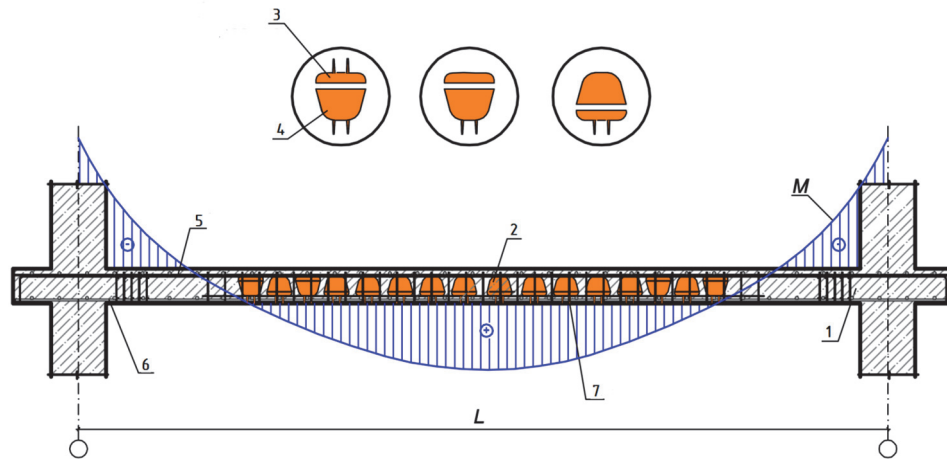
Конструкция чередования пустотообразователей в соответствии с расчетными усилиями в плите перекрытия: 1 — монолитная плита перекрытия; 2 — пустотообразователь; 3 — большее основание пустотообразователя; 4 — меньшее основание пустотообразователя; 5 — верхний арматурный каркас; 6 — нижний арматурный каркас; 7 — каркас фиксирующий пустотообразователи; L — пролет перекрытия; M — эпюра изгибающего момента.
